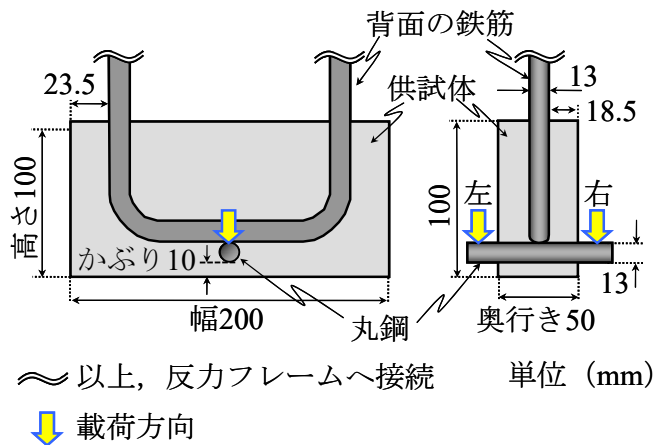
供試体の寸法および配筋 (かぶり 10mm)
